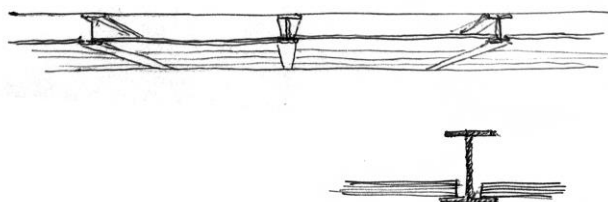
Representação da constituição do teto falso do último piso, com encaixe das placas de contraplacado na estrutura.
